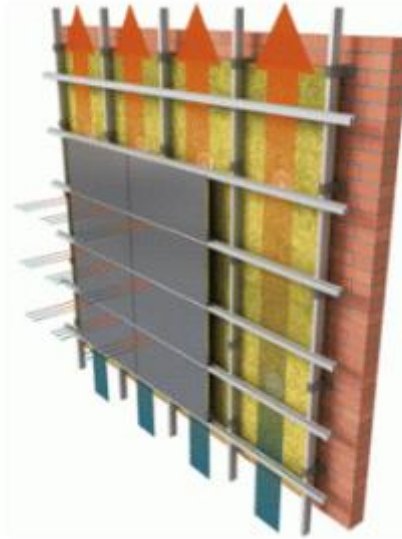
Fachada Ventilada. Fuente Imagen: <http://okoliarquitectos.es>
